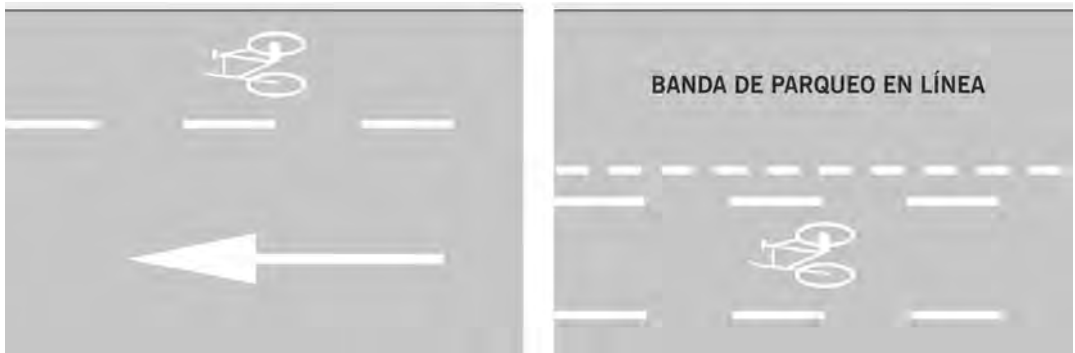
Línea discontinua de separación de banda de protección en calzada sin y con estacionamiento
